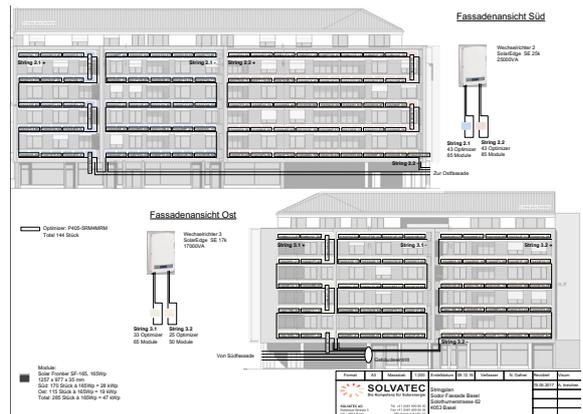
Layout und Stringplan Solaranlage an der Fassade
